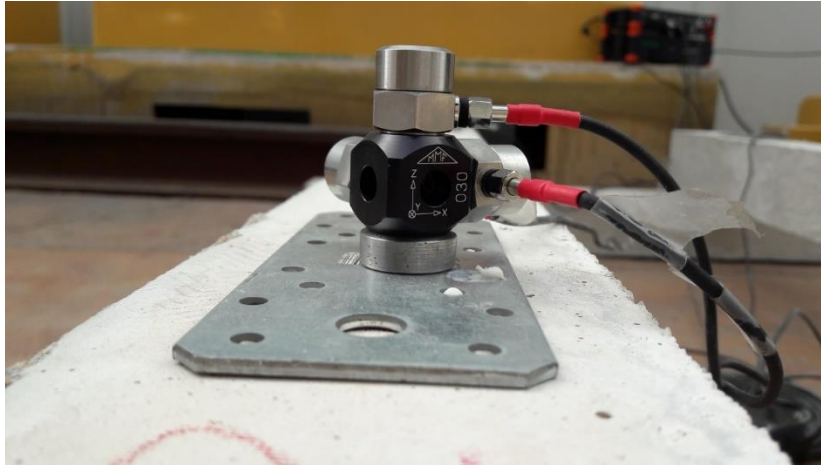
Detalle del acelerómetro instalado sobre la viga. Fuente: elaboración propia
